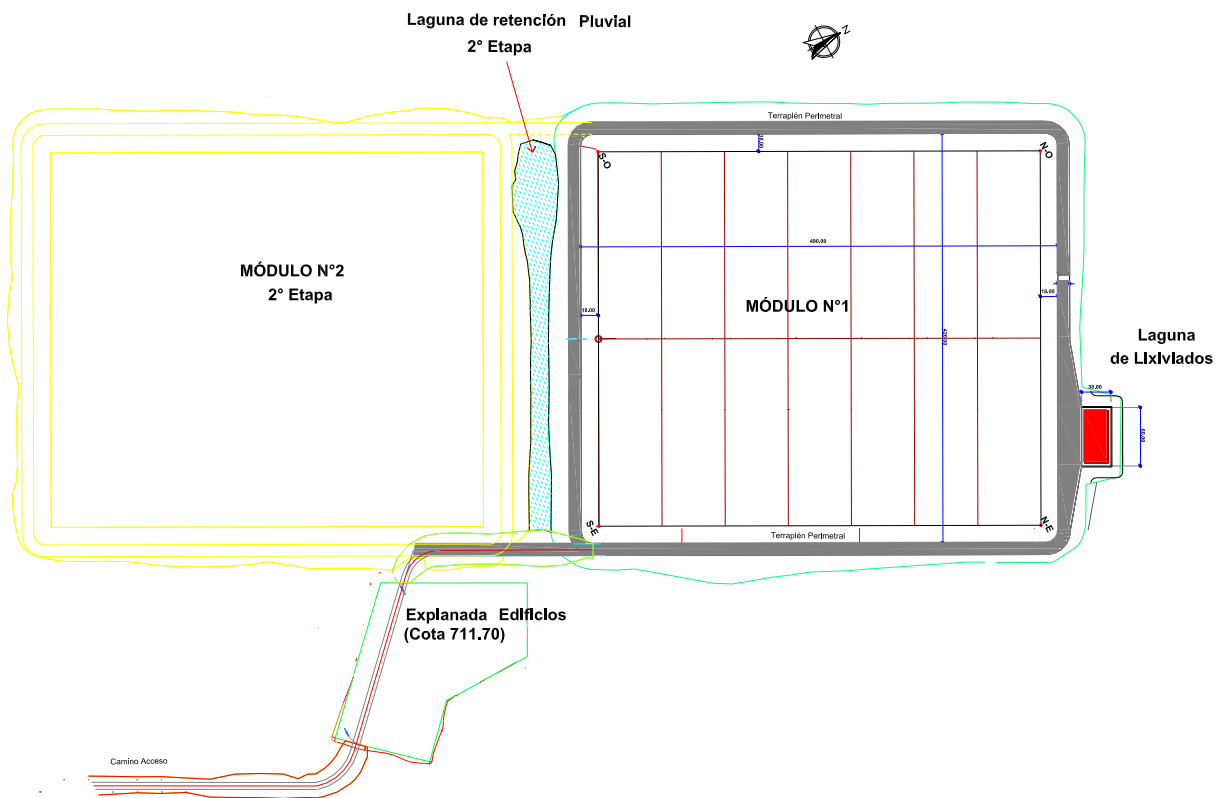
Posición de laguna de retención Pluvial y etapas constructivas
